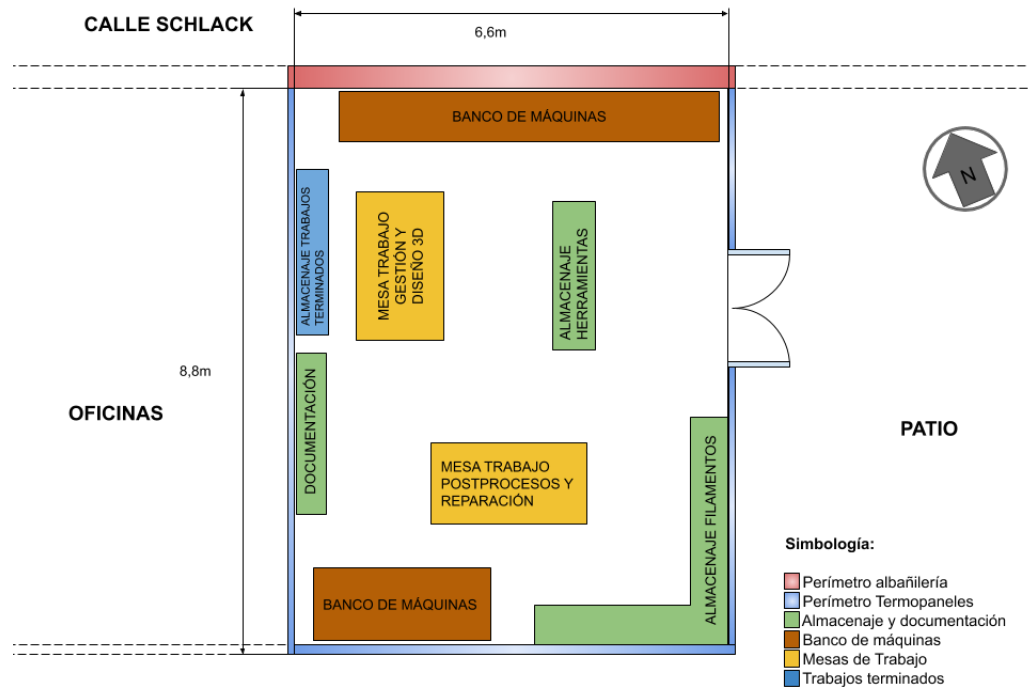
Layout y simbología del taller de impresión 3D.
